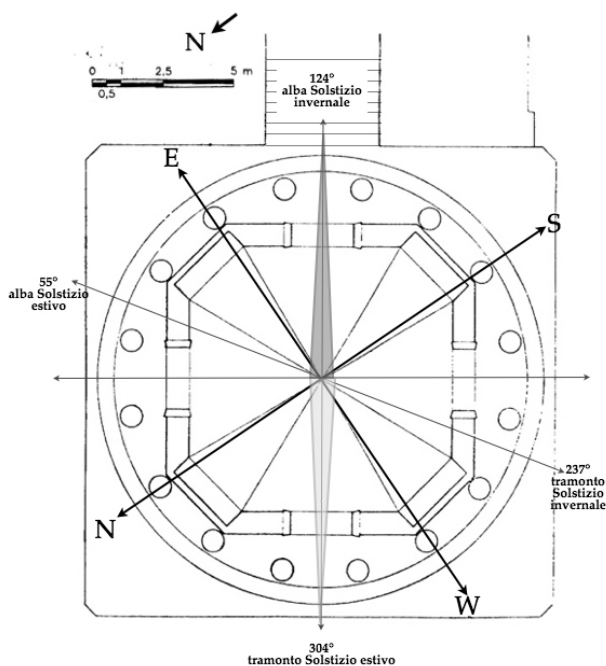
Tempietto al piano superiore di Roccabruna, pianta ricostruita con orientamento astronomico (elaborato da Lugli, 1940).
